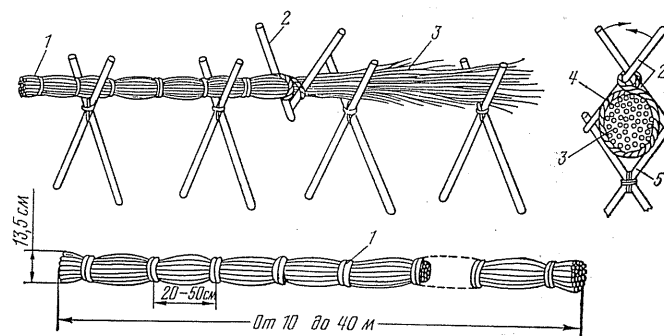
Изготовление фашины: 1 — перевязка; 2 — сжим; 3 — хворост; 4 — веревка сжима; 5 — козлы
